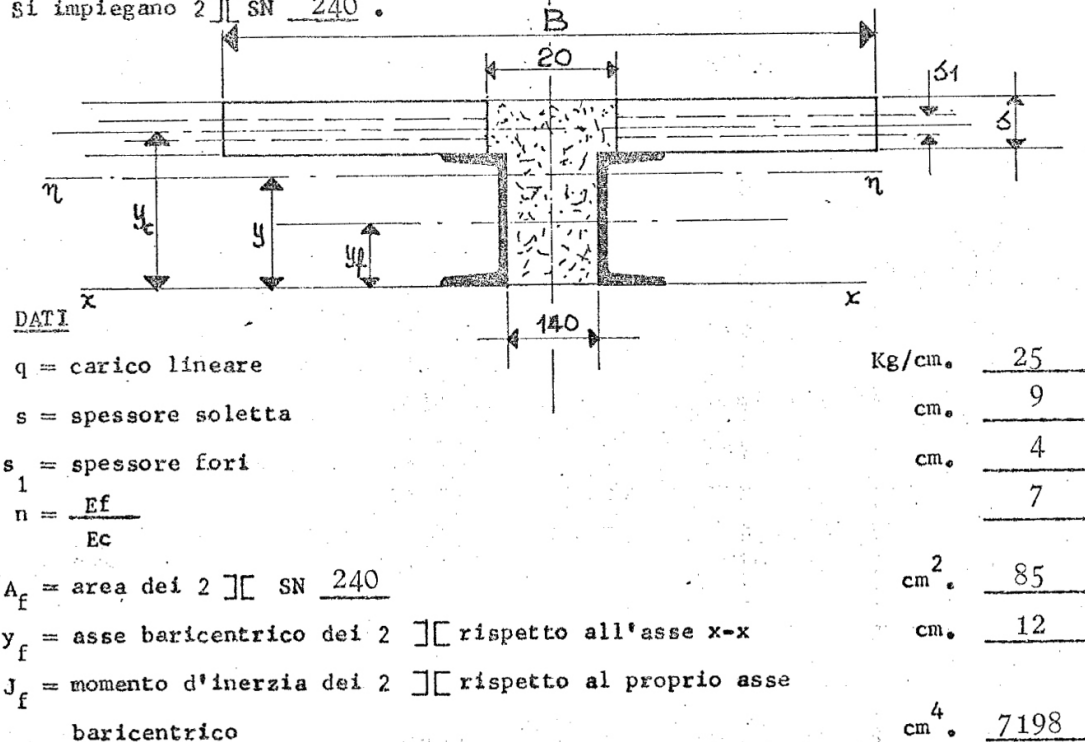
Estratto del progetto originale: sezione tipo travi solaio di calpestio.
